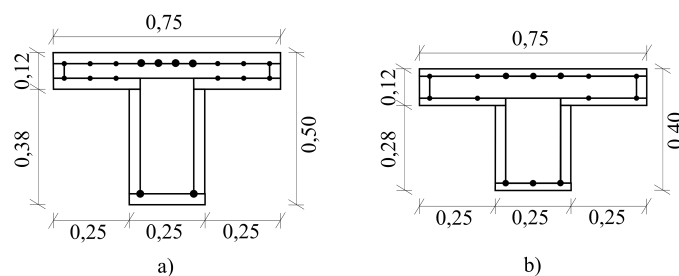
Geometria das secções transversais dos modelos das vigas testadas por a) Gião e b) Muhaj.
